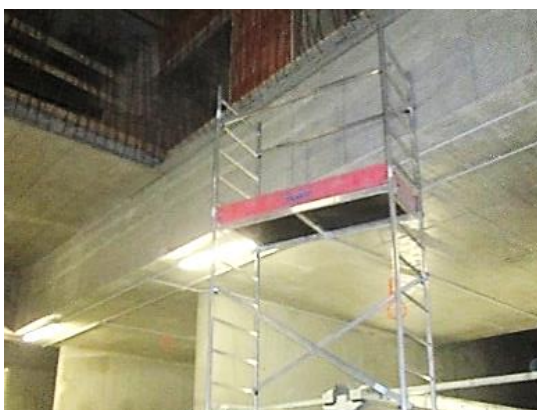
budova B – nepořádek na stavbě, špatné skladování materiálu (Archiv autora)
